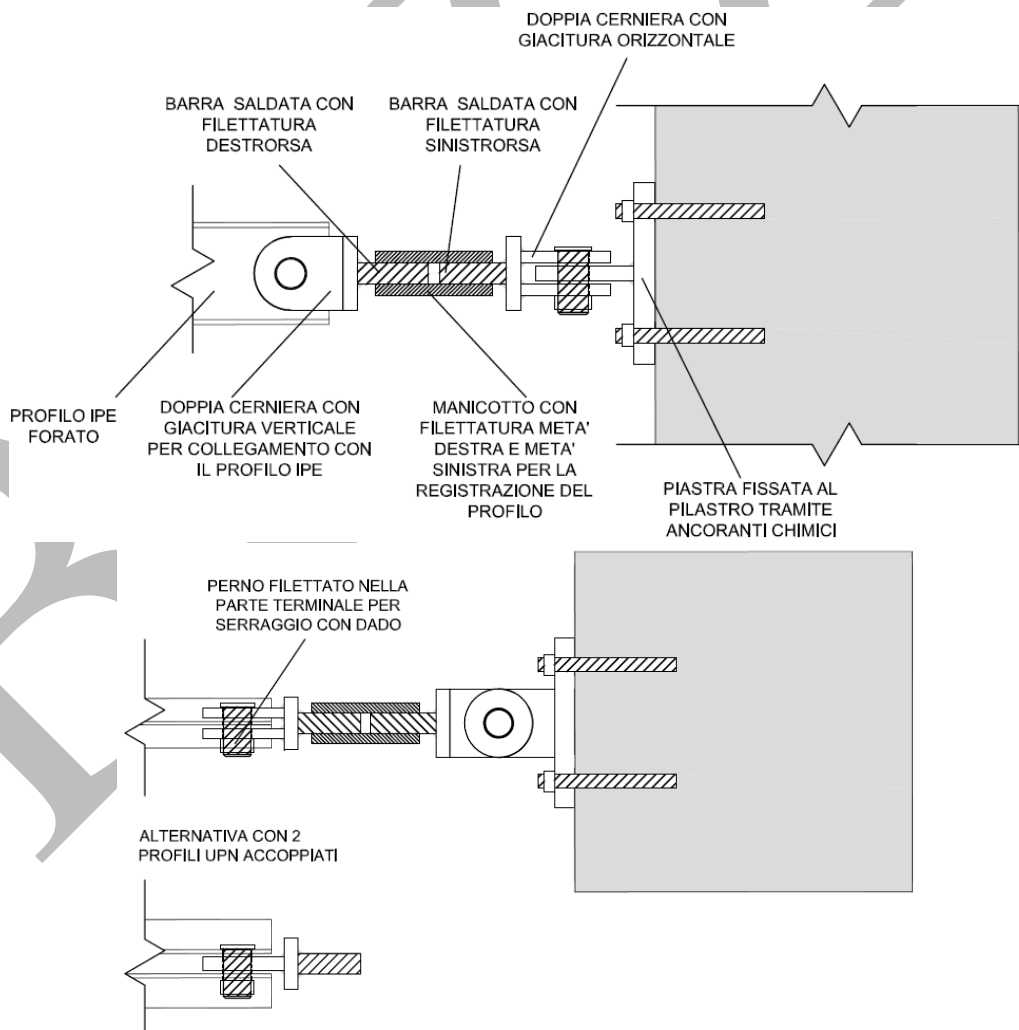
Collegamento dei pilastri tramite profili metallici.
